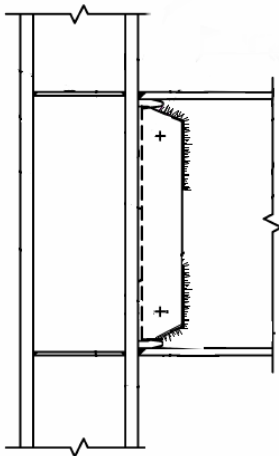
Assemblage de poutres où les ailes sont soudées à l'aile du poteau et où l'âme est soudée à un gousset soudé sur l'aile du poteau ; les boulons servent en phase de montage.
